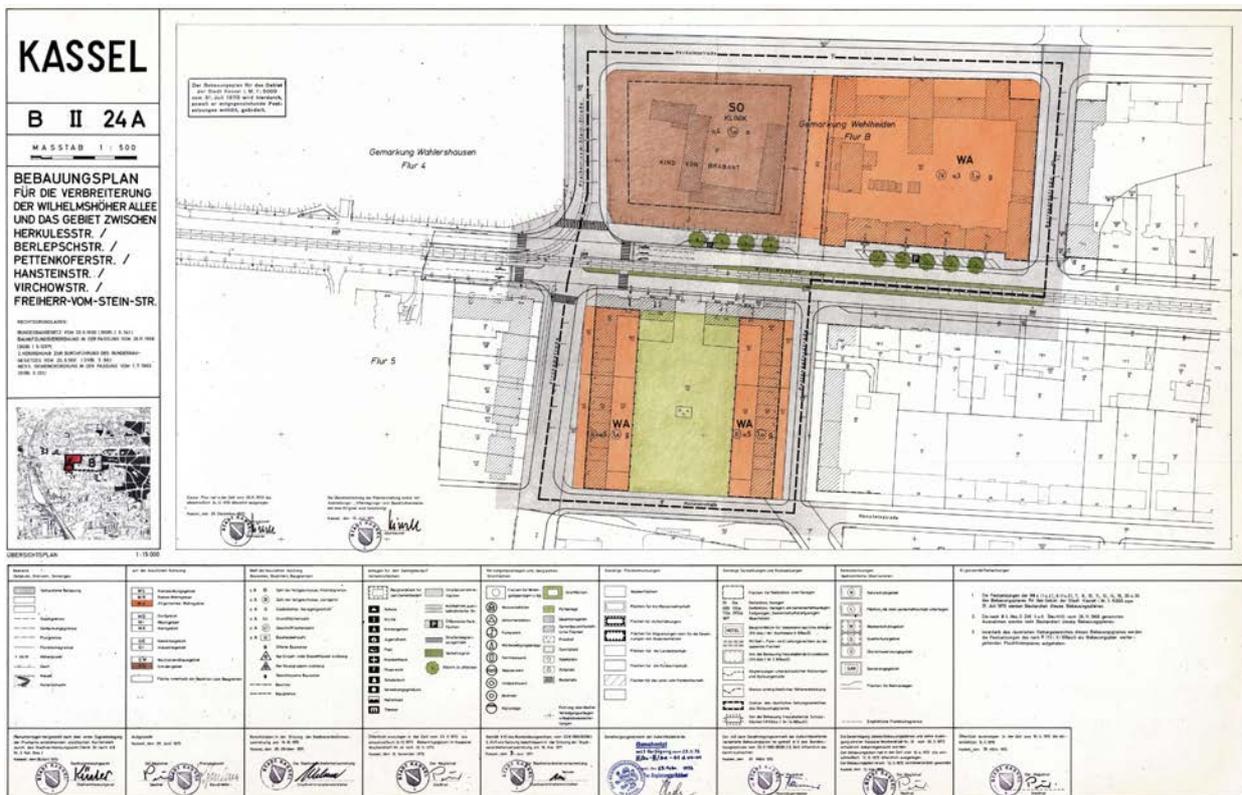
Bebauungsplan Nr. II/24 A für das Gebiet zwischen Herkulesstraße, Berlepschstraße, Pettenkoferstraße, Virchowstraße und Freiherr-vom-Stein-Straße der Stadt Kassel (Quelle: Stadt Kassel)
